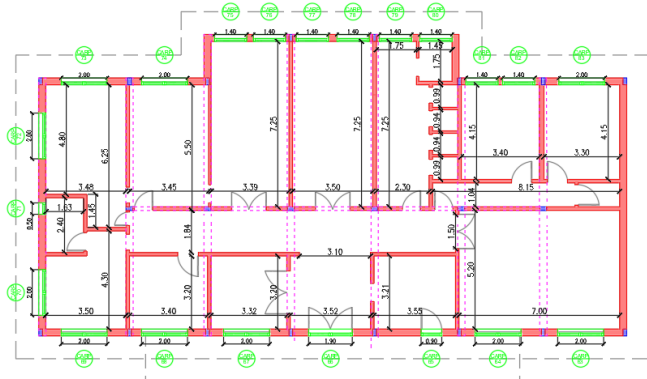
Edificio S3- Esquema estructural y constructivo
